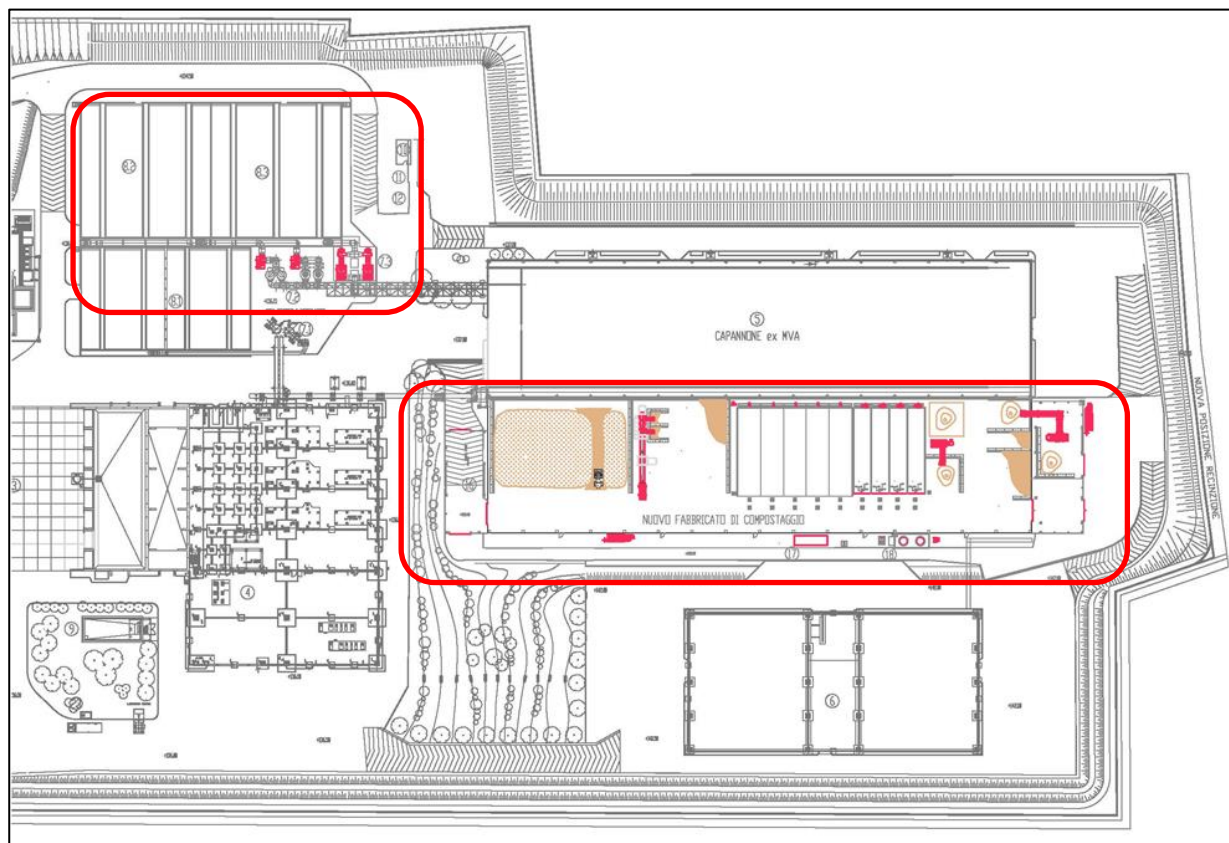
Layout dell'impianto STIR con individuazione dell'area di intervento
